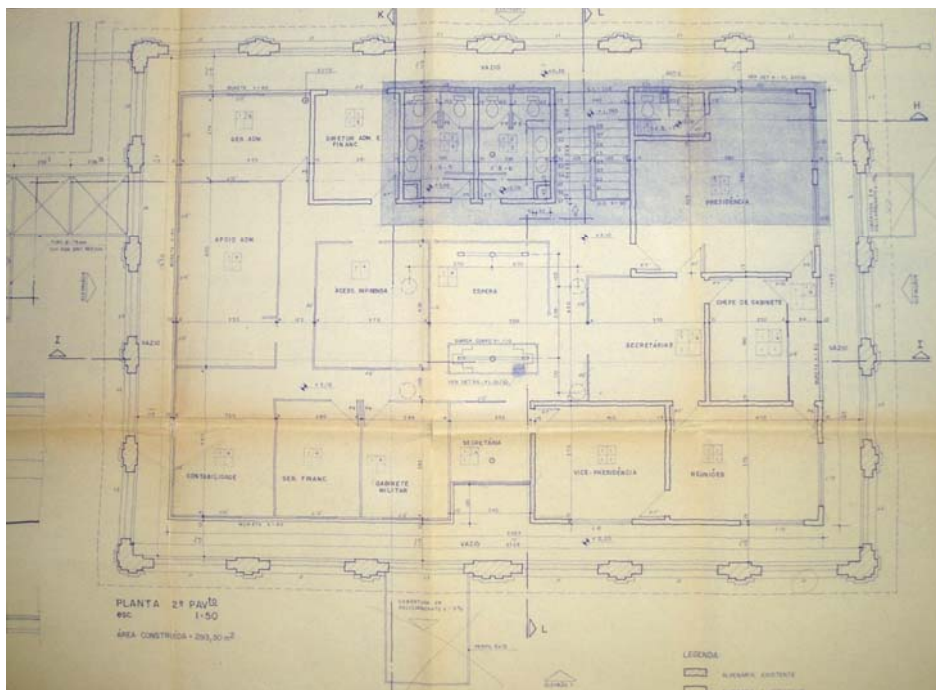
Fotografia da Planta Segundo Pavimento (Arquivo do IEPHA-MG).
